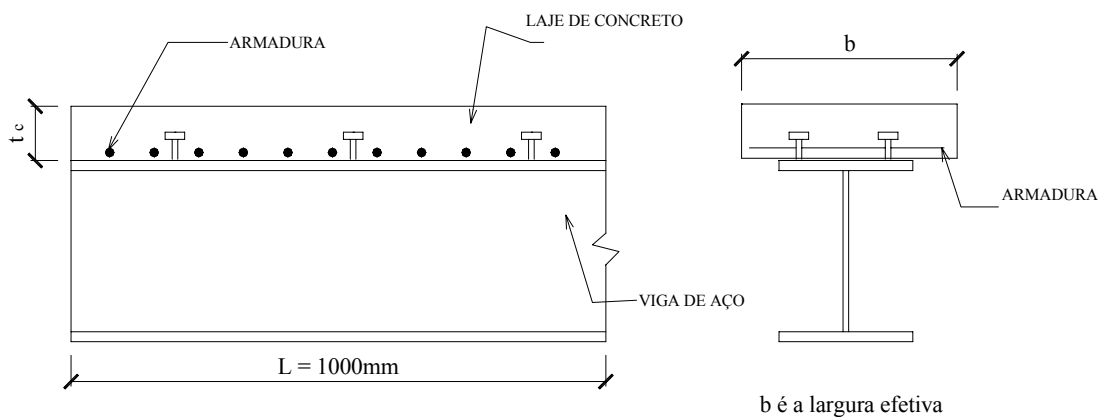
Disposição das armaduras transversais (adicionais) na laje de concreto, TRISTÃO (2002).
